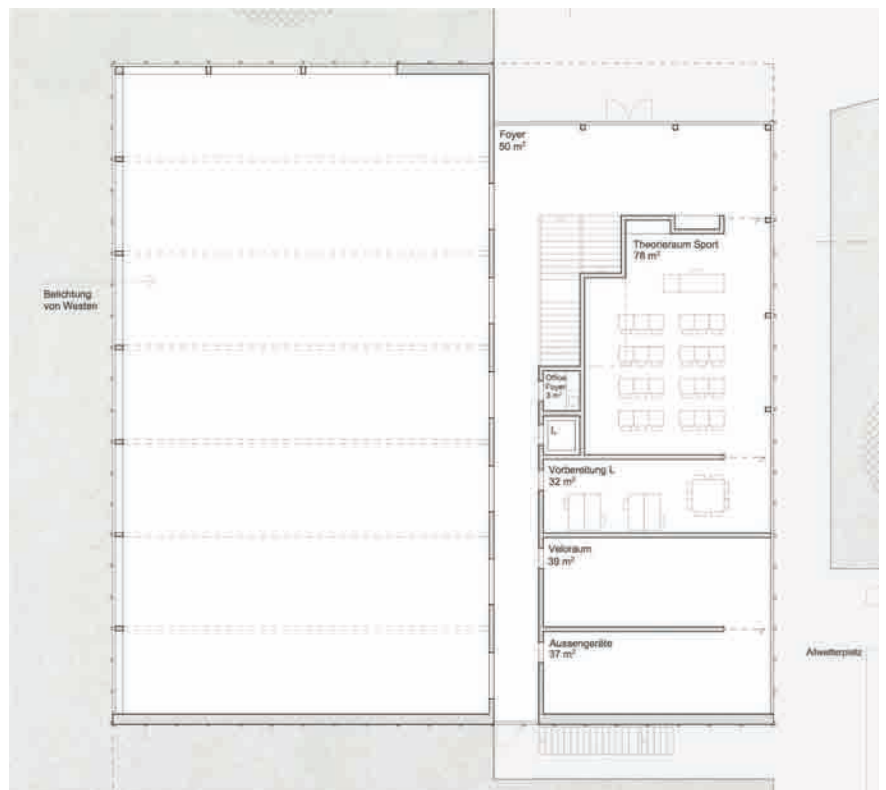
Grundriss Unter- / Obergeschoss
